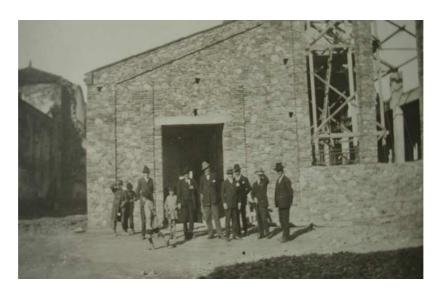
Plaza de Abastos de Llerena, en construcción, año 1927. Fotografía: Juan José Ortega Gómez.
